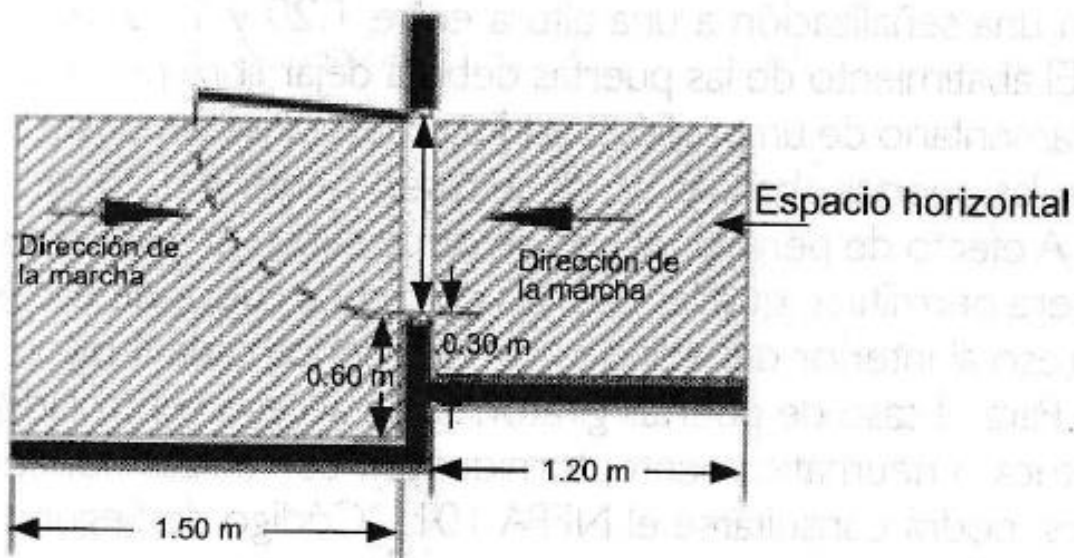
B. Puerta espacio horizontal—planta.
